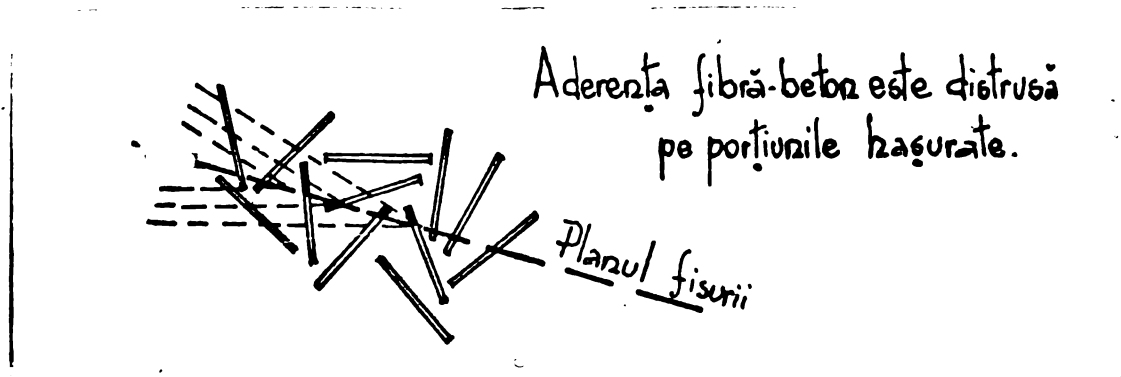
Schematizarea propagării fisurii și distrugerea aderenței fibre-beton, pentru un element din beton cu fibre.
